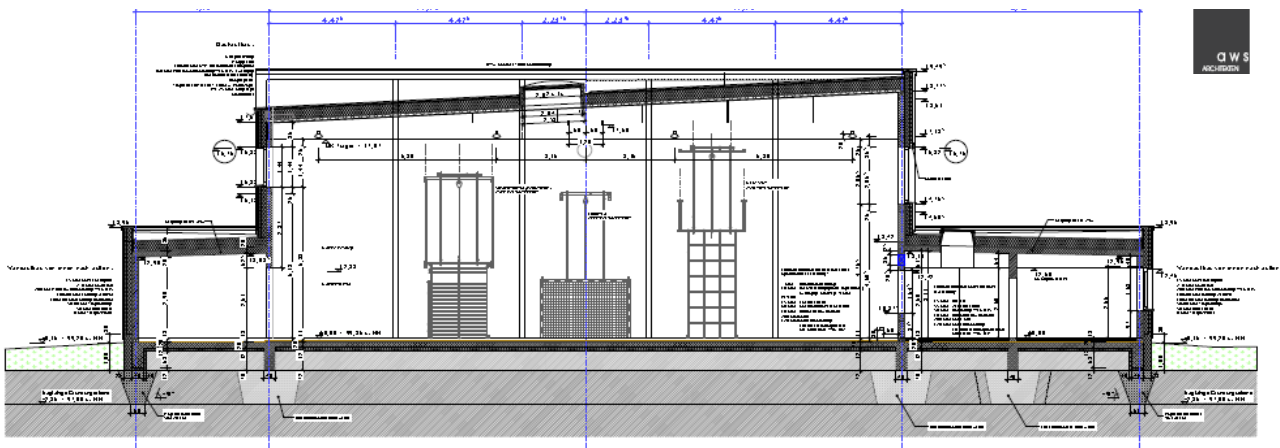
Querschnitt Gebäudehülle mit Gründung
